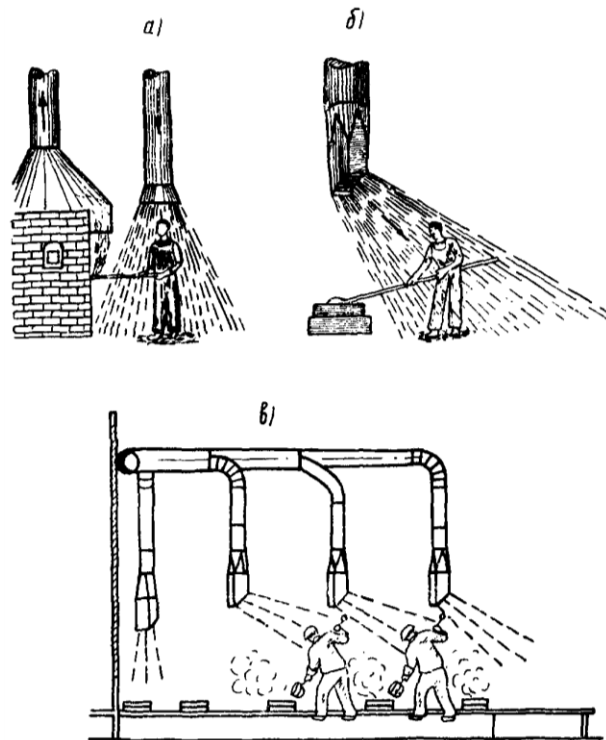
Повітряний душ: а - вертикальний; б - похилий; в – груповий
